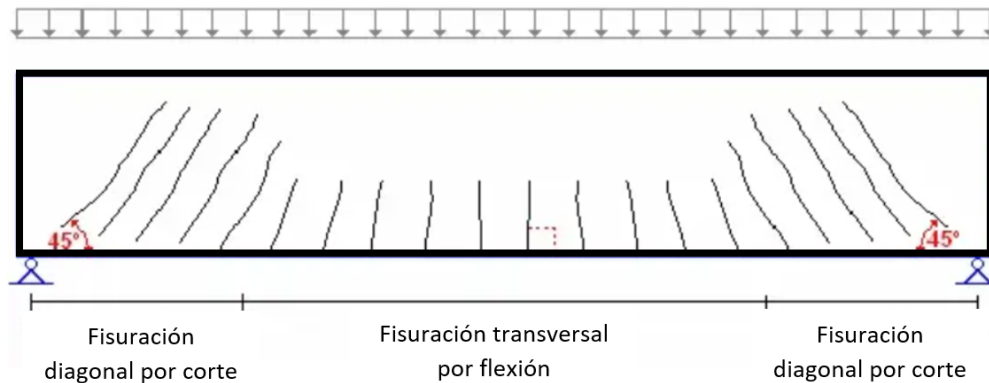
Mapa de fisuras en una viga simplemente apoyada.
